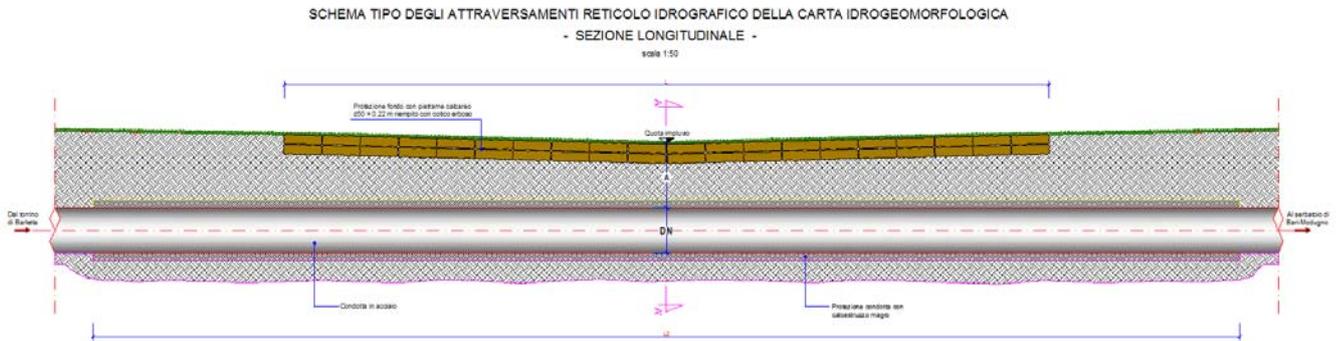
Sezione tipologica longitudinale di attraversamento impluvi.
